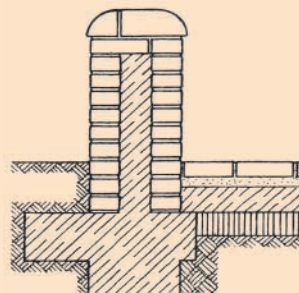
Muro con núcleo de hormigón y cubierta superior con saliente reducido.
